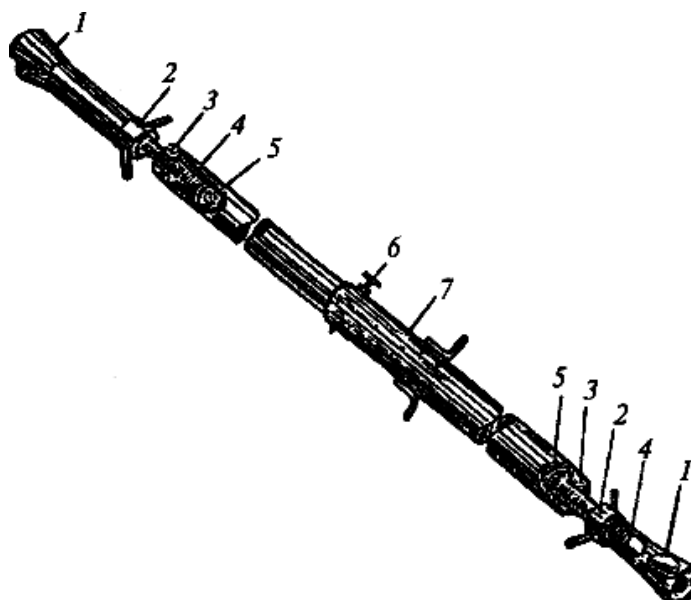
Подкос для монтажа панелей стен с запирающим штифтом:
